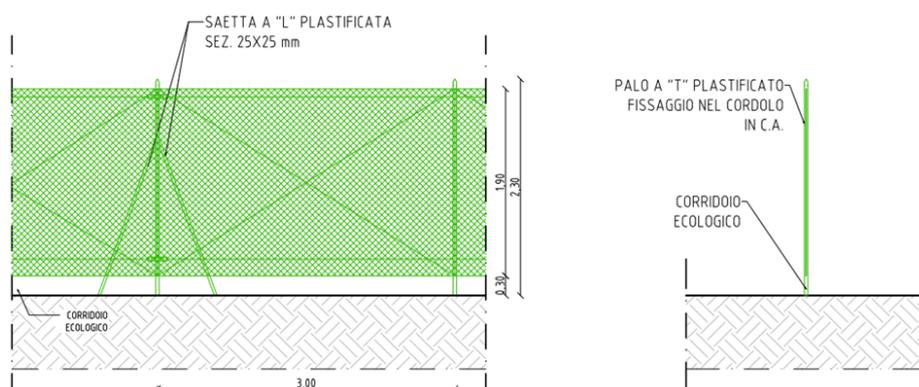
Dettaglio recinzione - Prospetto e sezione
